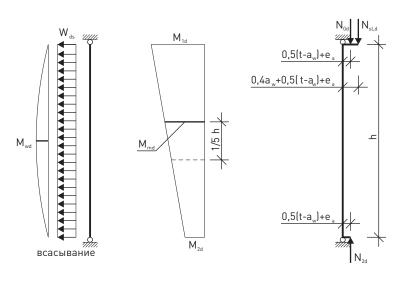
Расчетная модель колонны в наружной стене
